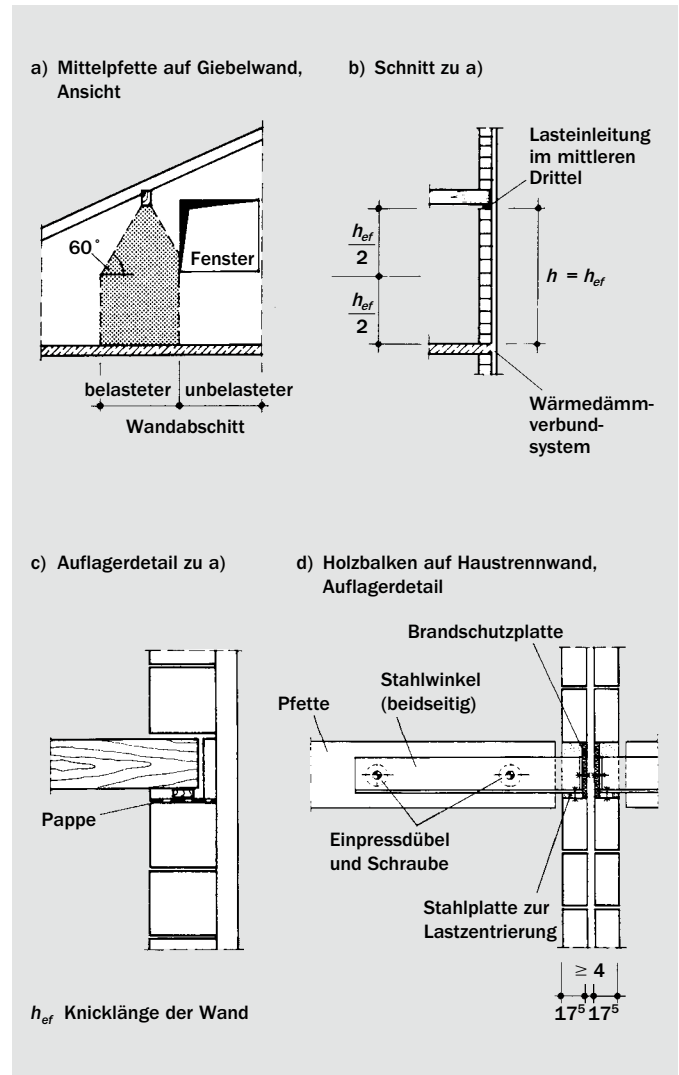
Belastung einer Wand durch Holzbalken (Pfetten)
